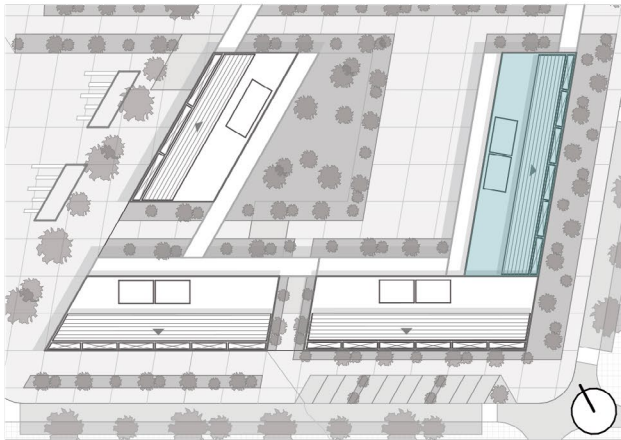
| Axonometría Fachadas | Fuente: Autoría propia. (2023).
